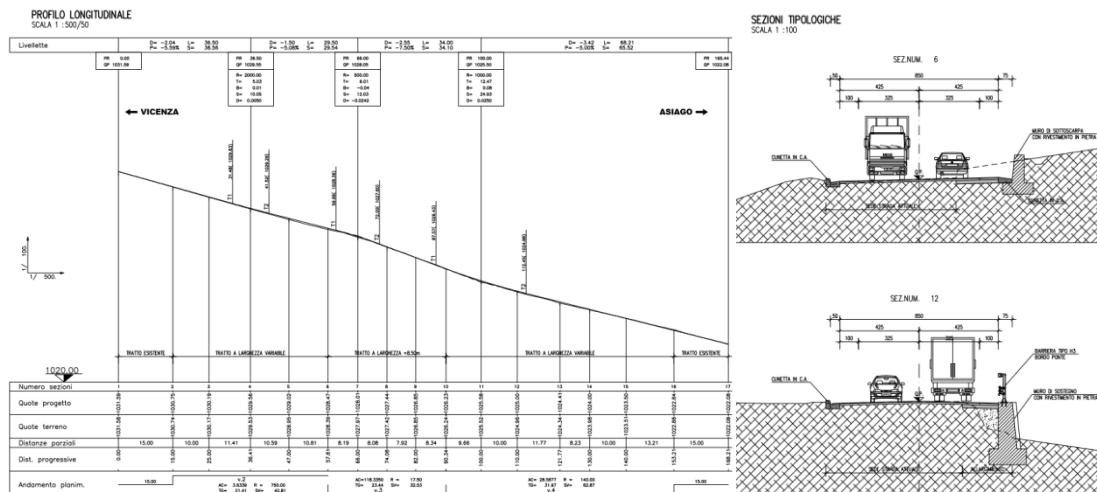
Intervento n.1 - Profilo e Sezioni
